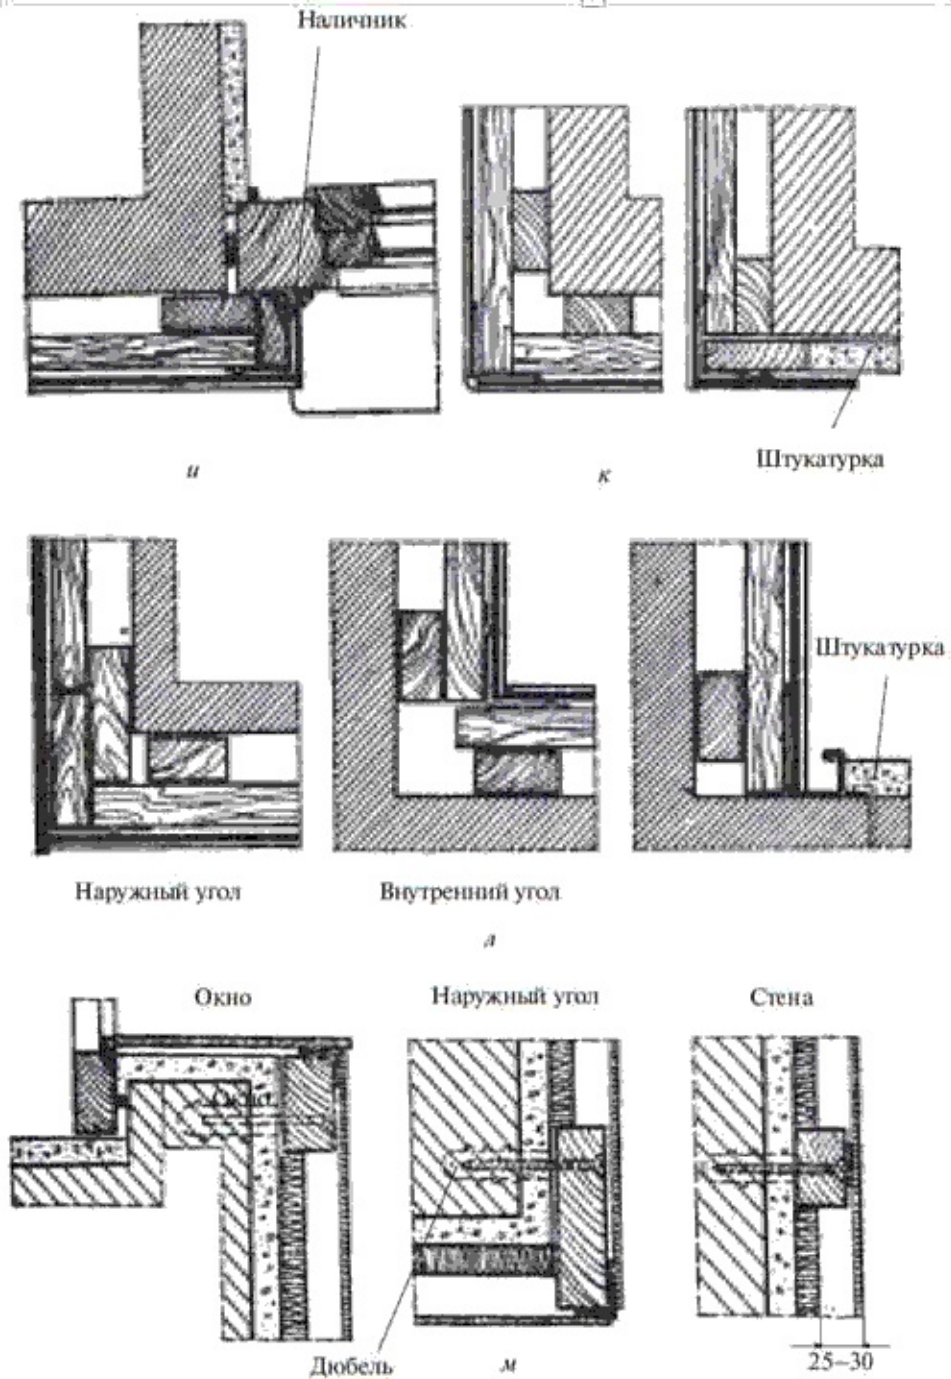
(продолжение). Крепление крупноразмерных листов на фасаде здания: и – узел крепления облицовки у оконного проема; к – конструктивное решение облицовки наружного угла; л – конструктивное решение облицовки на внутреннем и внешнем углах; м – сочетание облицовки крупно-размерными листами с теплоизоляцией
